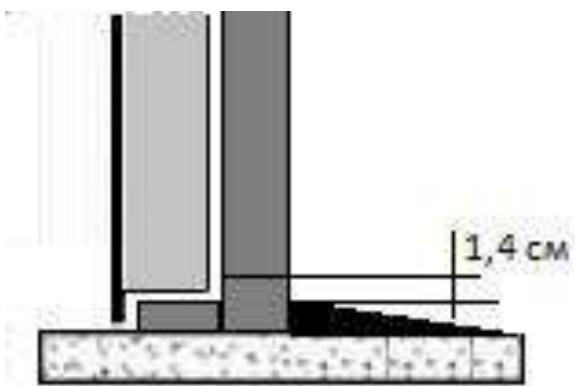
Приспособление входа в квартиру для инвалида на кресле-коляске
